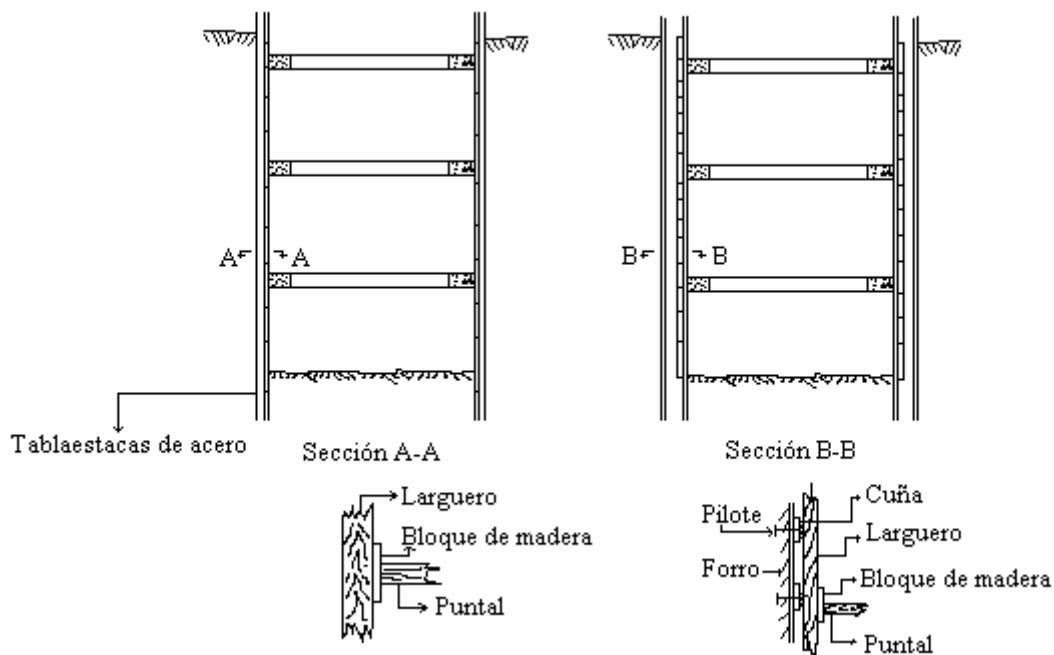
Secciones transversales en apuntalamientos de excavaciones profundas
